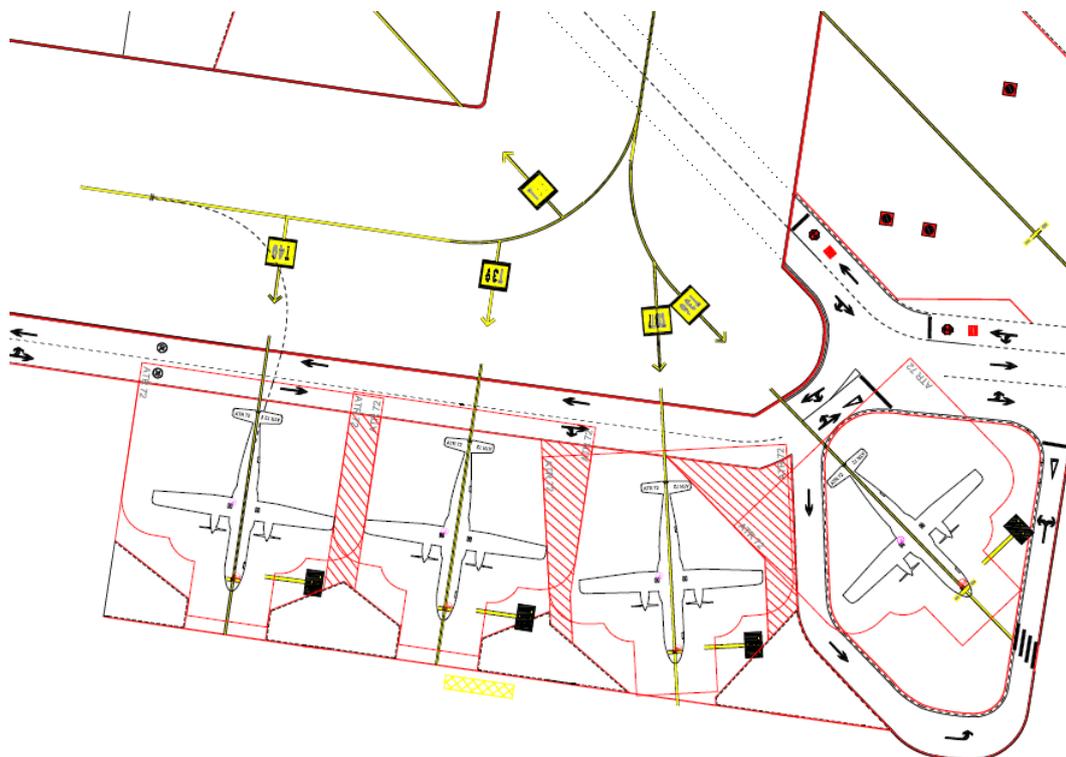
Plano de la zona de estudio tras la remodelación.
